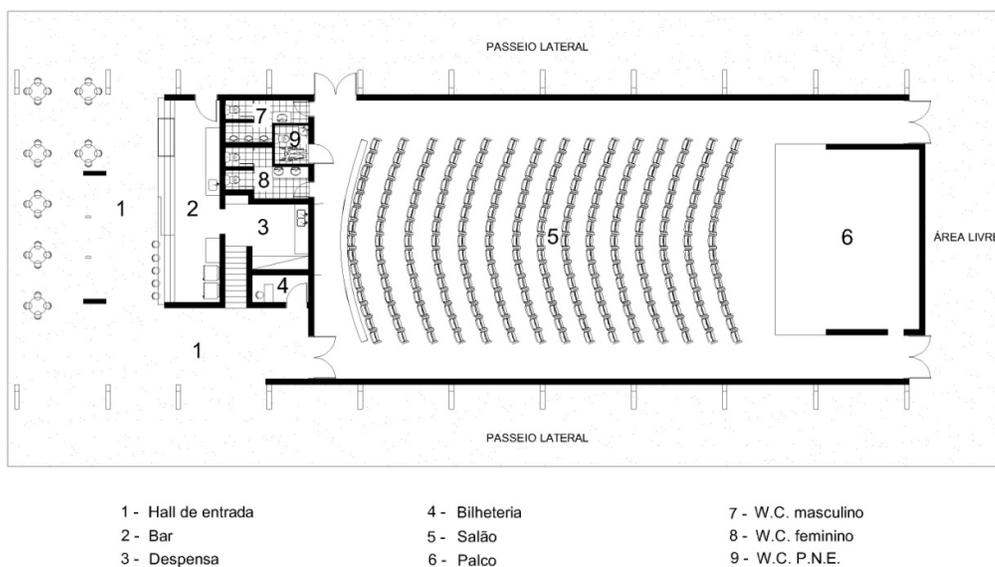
Planta de Layout do projeto de intervenção no Bloco do Cine-Teatro.
